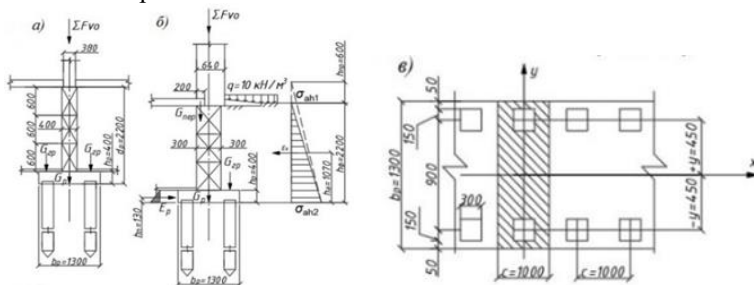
Расчетная схема ленточного свайного фундамента: а – центральное нагружение; б – внецентренное нагружение; в – схема ростверка в плане
